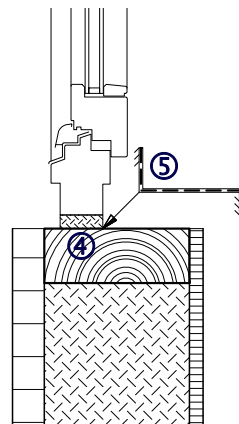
Die Fuge zwischen Fenster und Rohbauwand beträgt auch hier 15 mm und wird mit elastischem Dämmmaterial ④ ausgefüllt (z. B. Faserdämmstoff). Die Luftdichtung / Dampfbremse ⑤ wird zum Fensterbankfalz verklebt.
